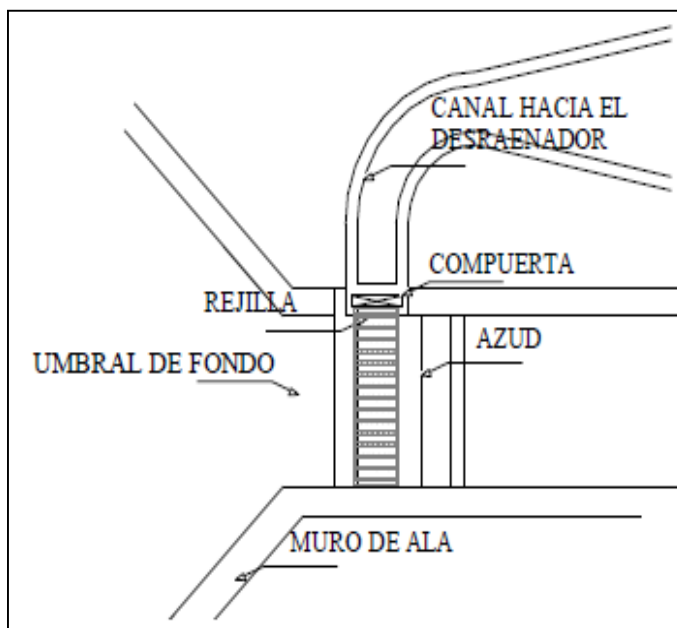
Partes de la obra de toma tipo Tirol, vista en planta
